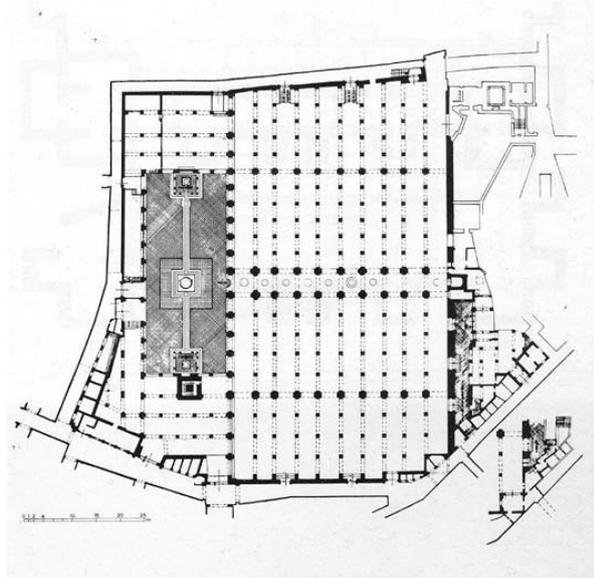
Fès. Planta da Mesquita Qarawiyyin.
